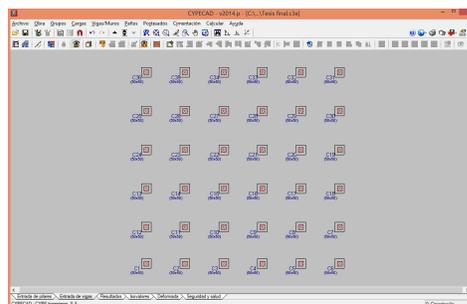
Disposición de las zapatas para cada una de las columnas
